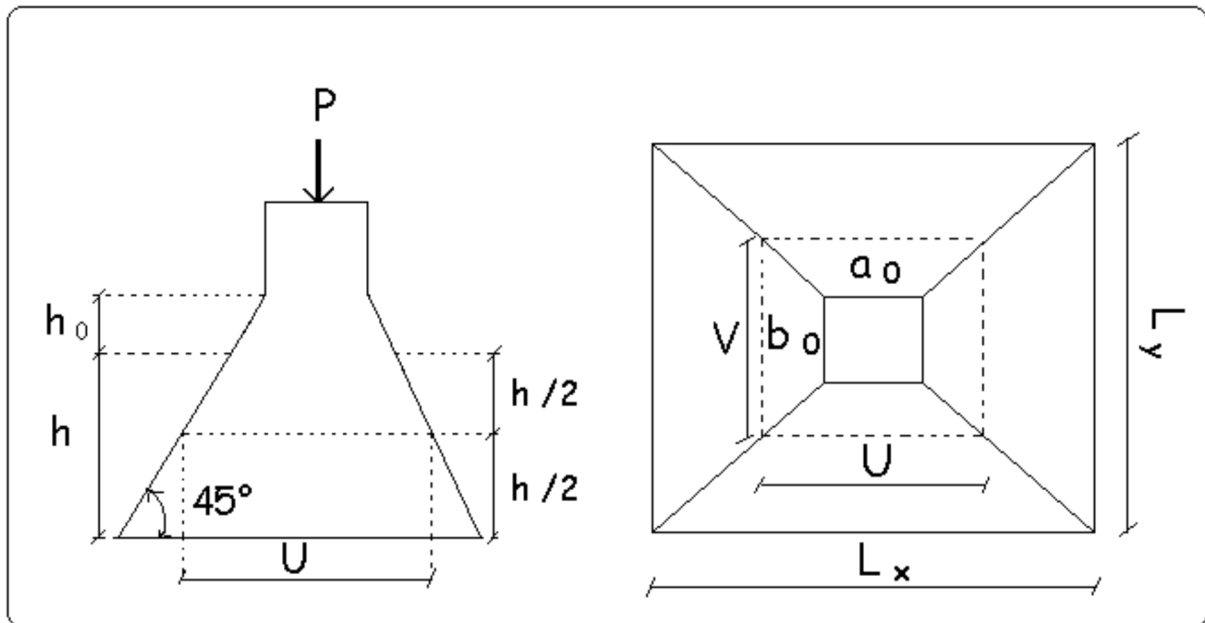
Schéma de la dalle d'ascenseur et sa surface d'impact.
